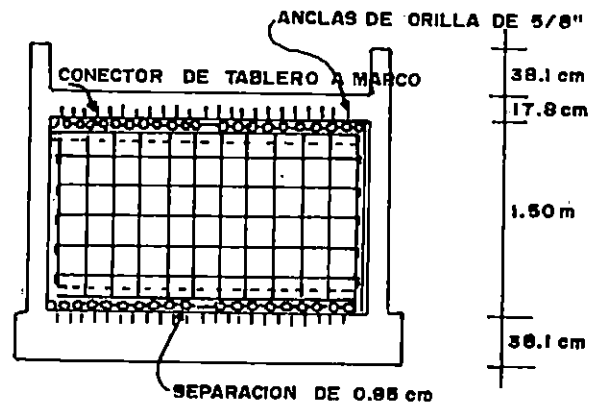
b - MURO DE TABLERO PRE-FABRICADO INDIVIDUAL
